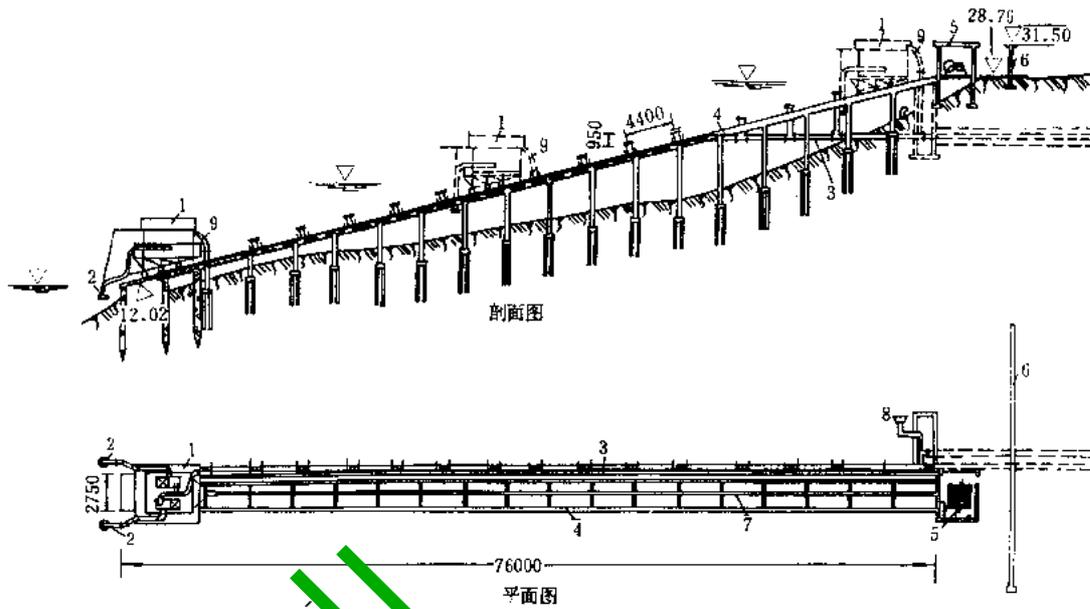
斜桥式泵车布置图 (尺寸单位: mm)
